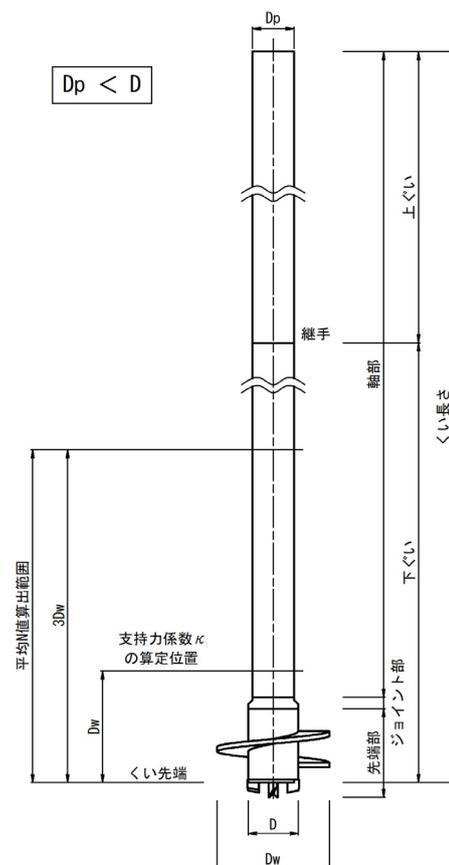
基礎ぐいの構造 (TG ジョイント有の場合)
